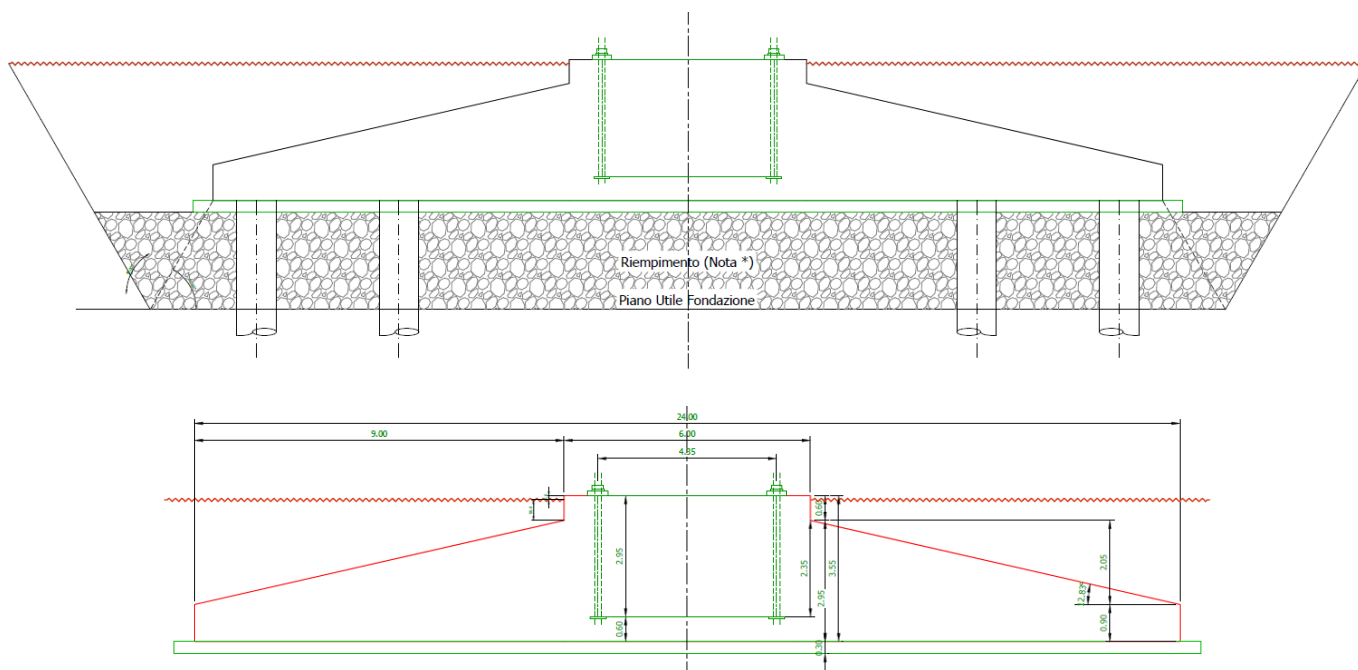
Tipica Sezione di scavo con ingombri di massima del Plinto di Fondazione degli aerogeneratori
